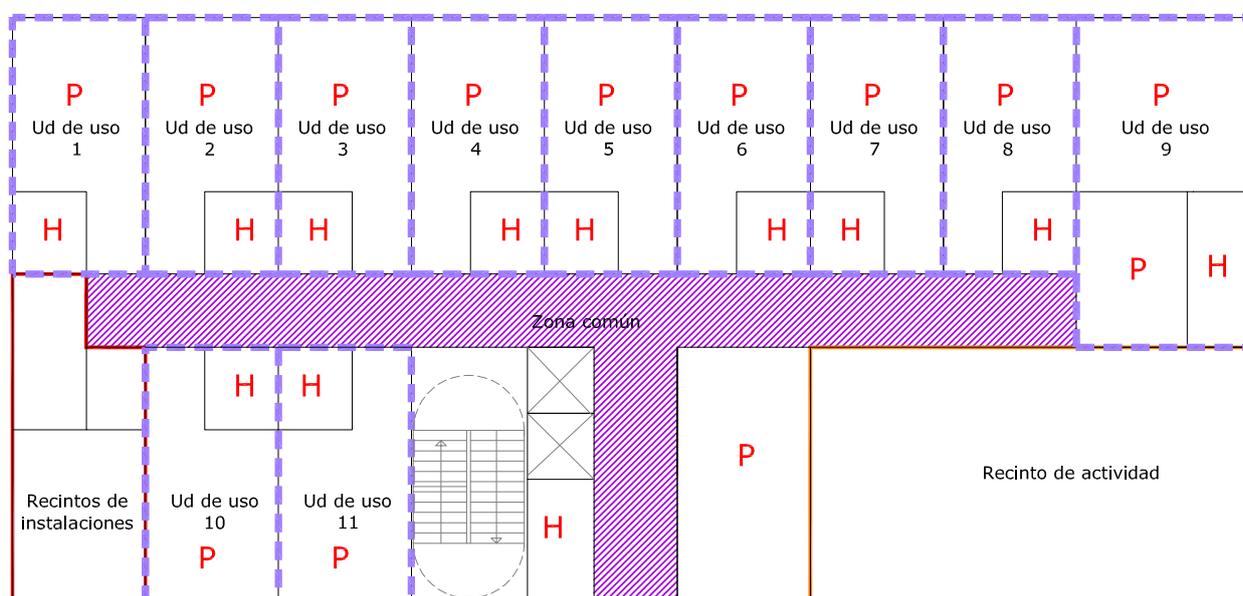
Esquema en planta de un edificio residencial público. Las exigencias de absorción acústica se aplican al área rallada.
